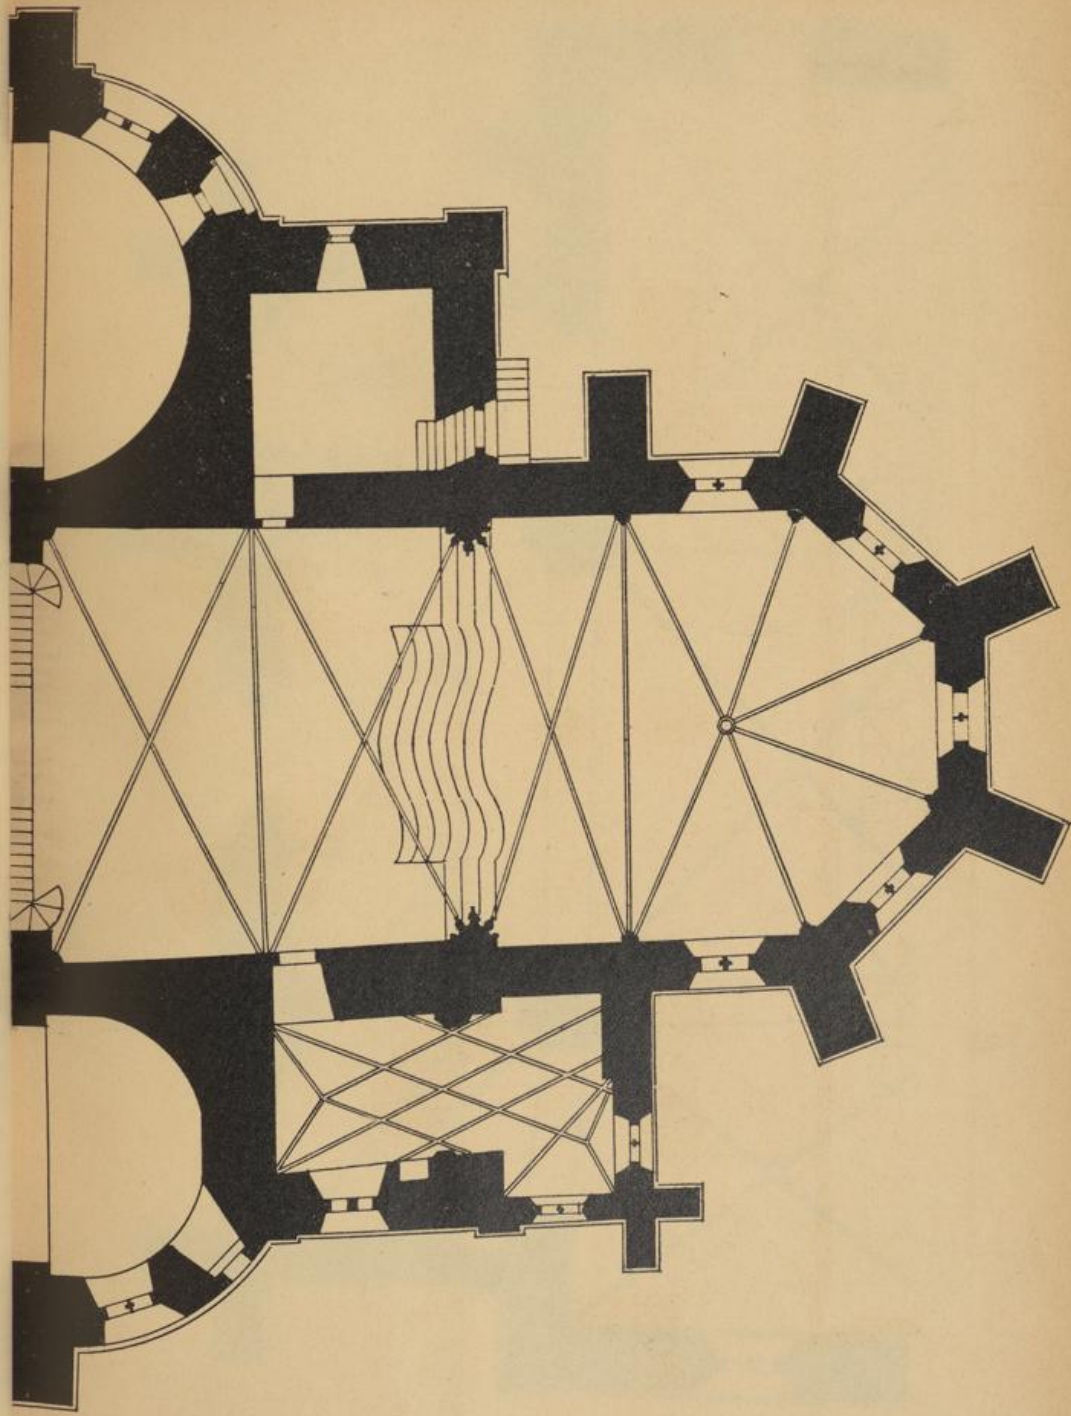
Breisach. Münster, Grundriss der Unterkirche.
